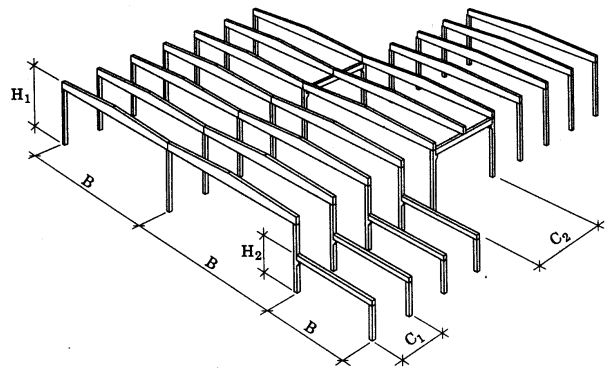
Portiekconstructie met primaire en secundaire dakbalken
